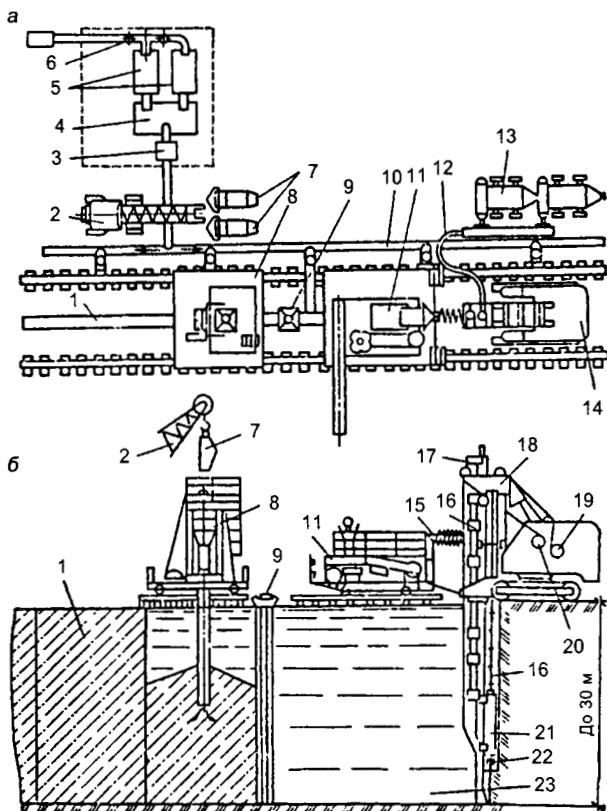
Схемы расположения оборудования (а) и производства работ при устройстве стен сооружения способом «стена в грунте» (б):
